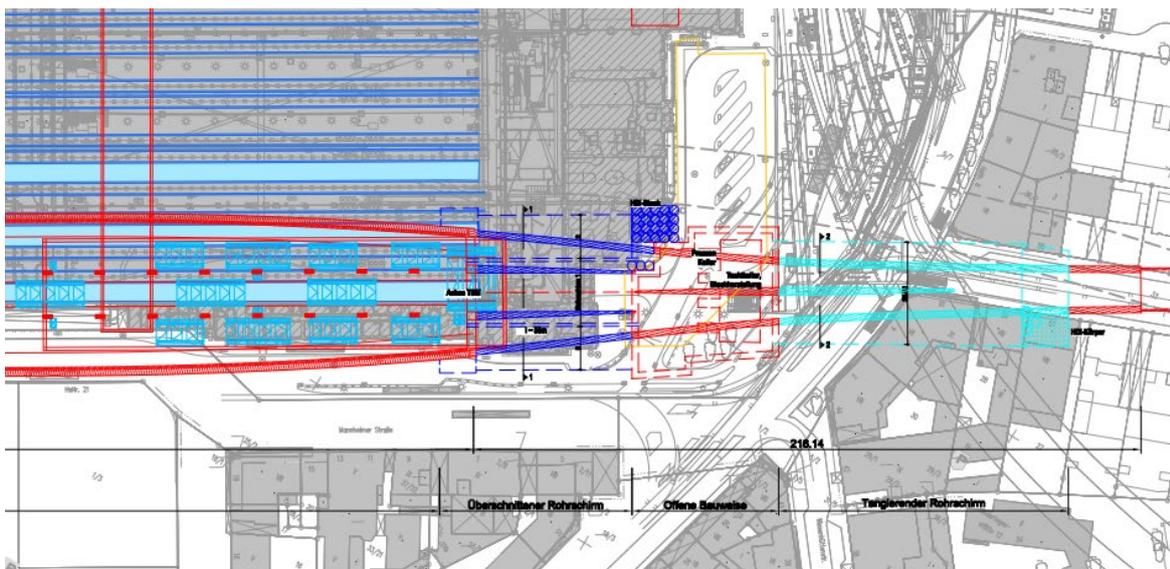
Grundriss Verzweigungsbereich Typ A
